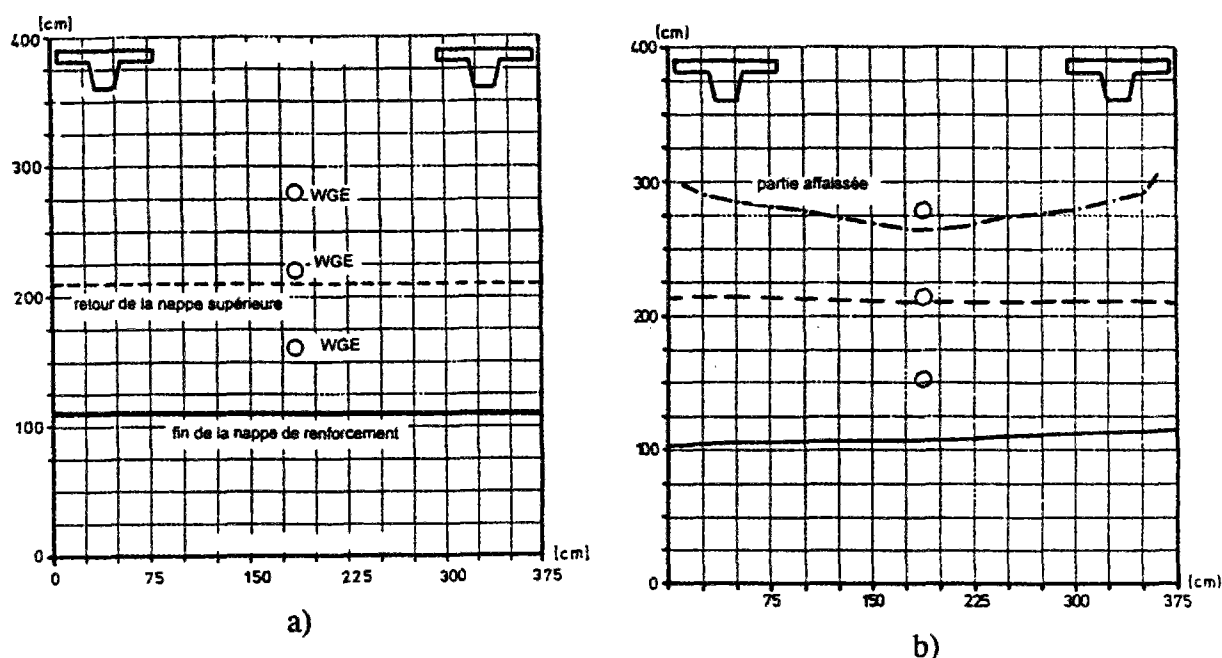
Etat de la surface de la première couche avant le chargement (a) et après la rupture (b)
